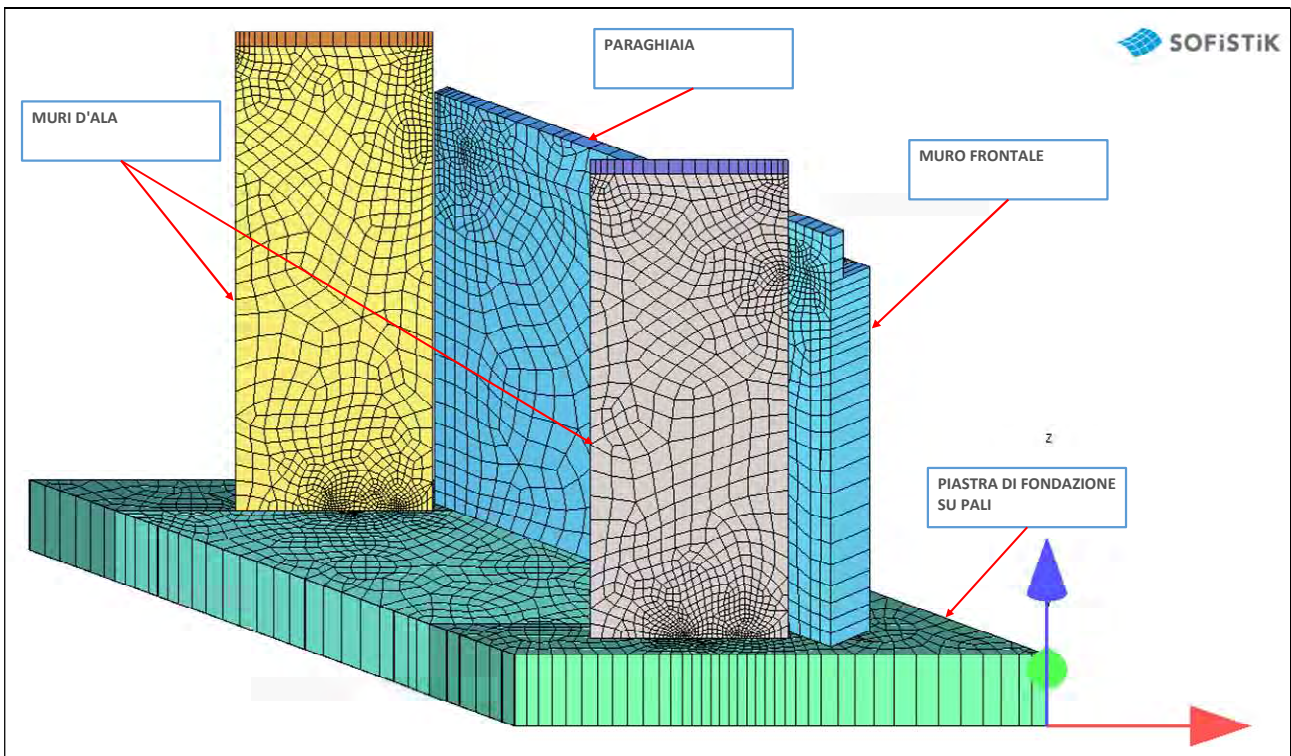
Modello globale spalla: muro frontale, muri d’ala, paraghiaia, piastra di fondazione
